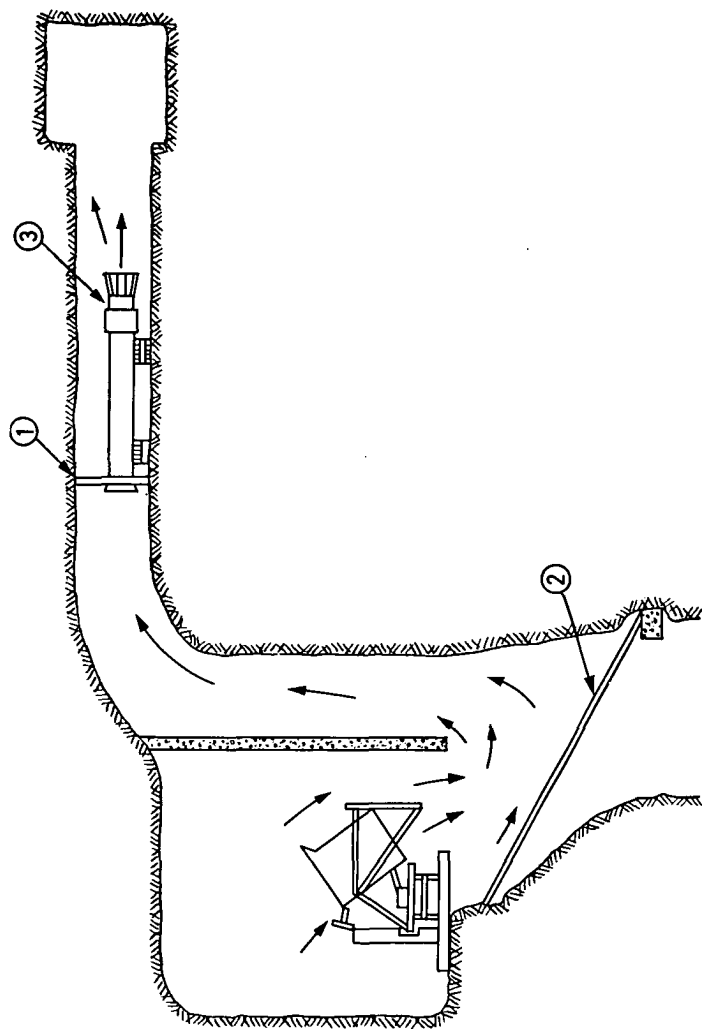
Coupe d'une installation de culbutage dans une station de transbordement.
